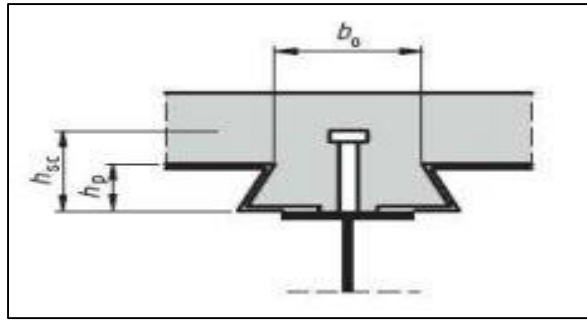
Une section d'une dalle mixte (tôle, dalle de béton et le goujon)
